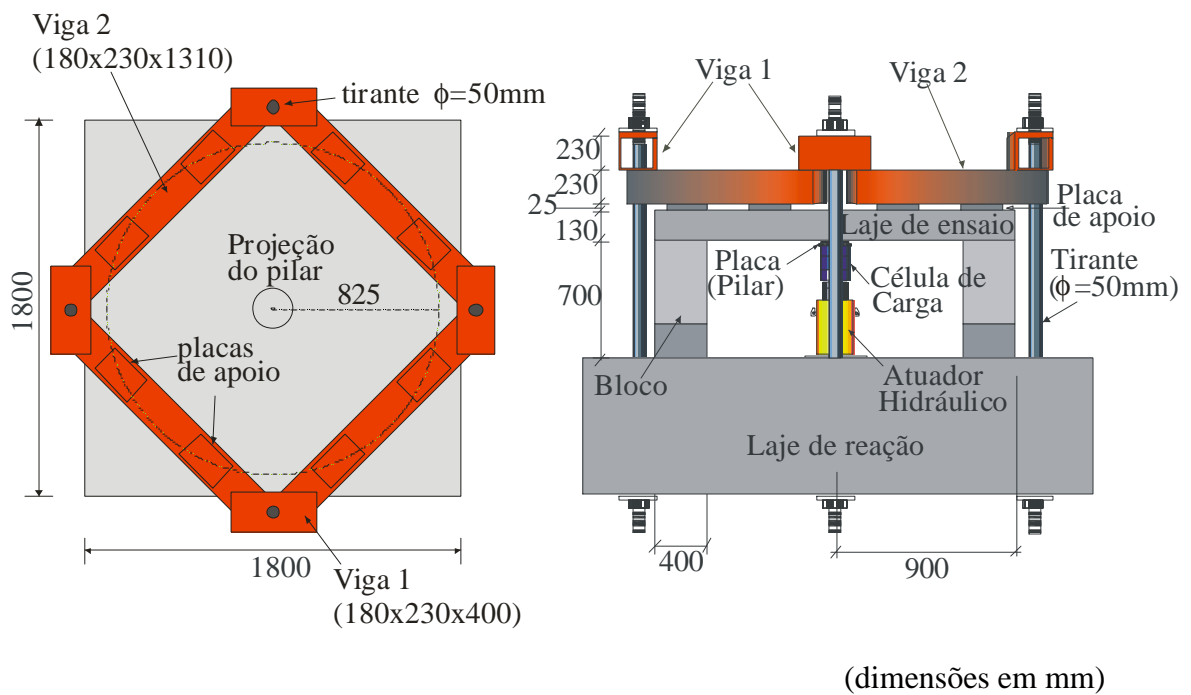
Características das lajes ensaiadas – dimensões em mm
